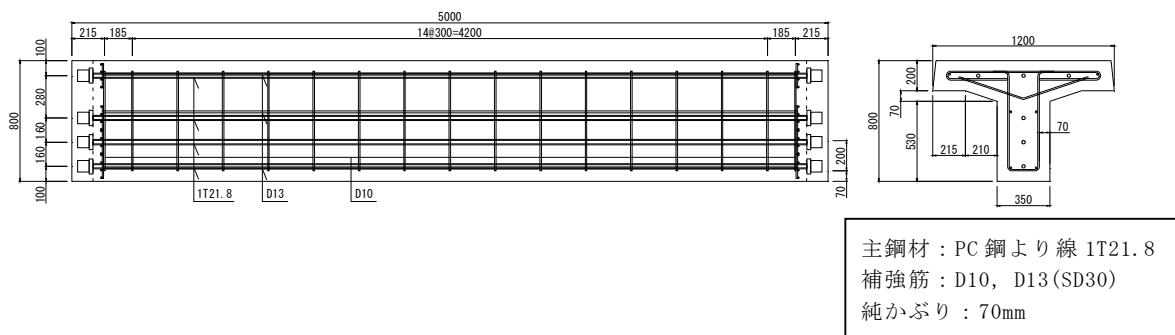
試験体形状（ポストテンション方式大型試験体）
